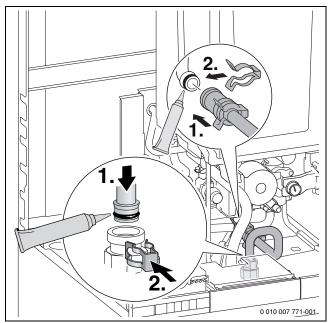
Raccorder le tube raccord entre le retour du ballon et le bloc thermique
